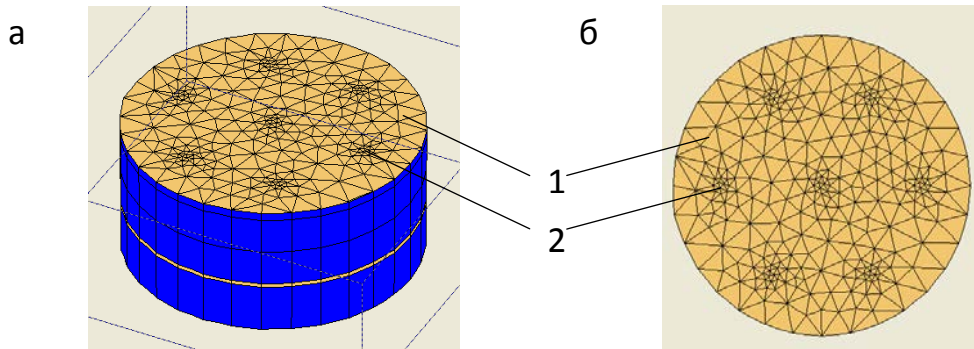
Модель зразка армованого ґрунту з відсотком армування 2,2 % (7 ГЦЕ): а – загальний вигляд закріпленого зразка; б – вид зверху; 1 – ґрунт, 2 – елемент армування
